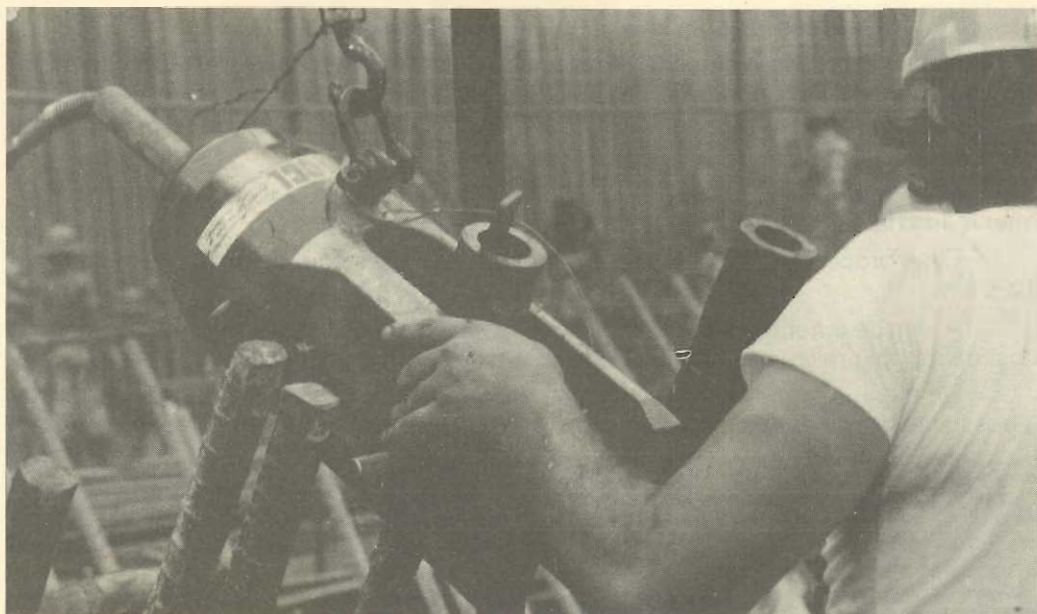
Equipamento posicionado para execução de emenda prensada "IN SITU"
